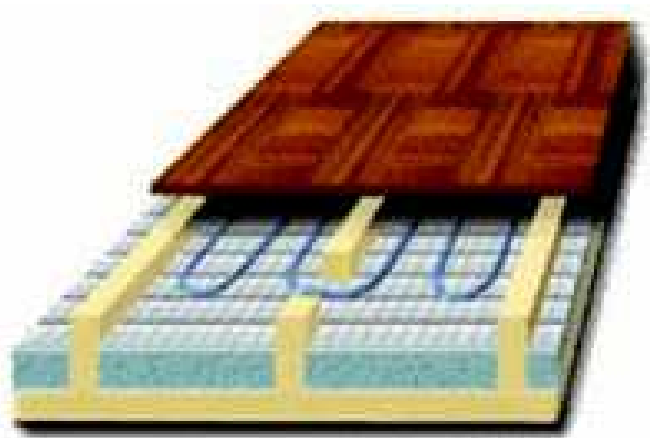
Укладки кабеля в домах с деревянными перекрытиями
